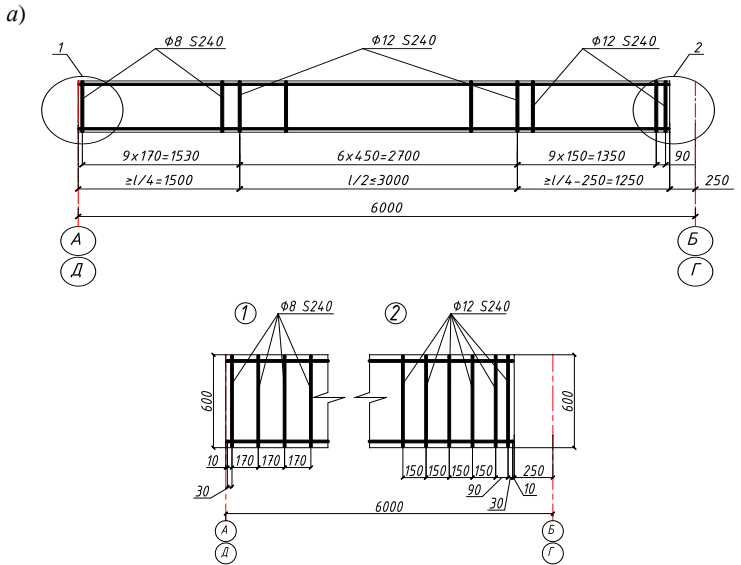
Схема армирования ригеля поперечными стержнями:
